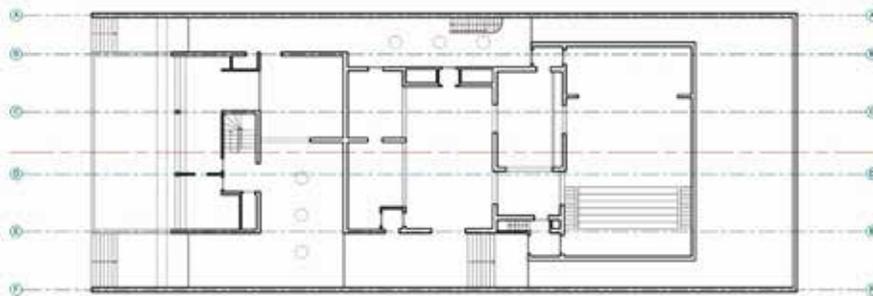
Matriz de bandas. Planta baja. Radio Nacional Mendoza
